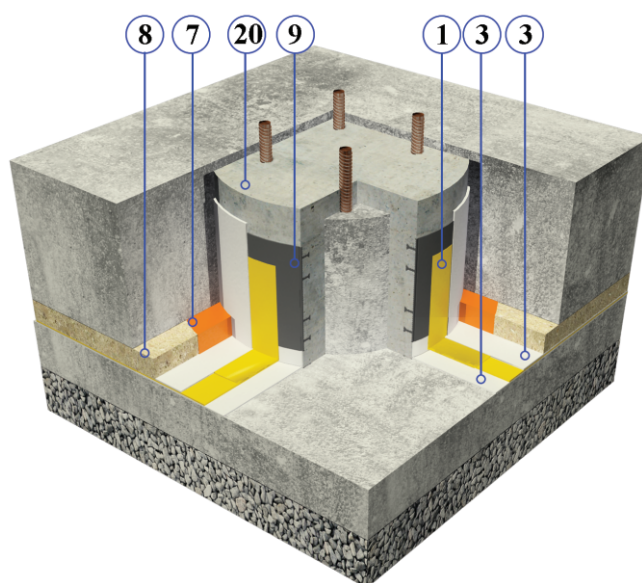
Гидроизоляция оголовка сваи с применением гидроизоляционной ленты.
